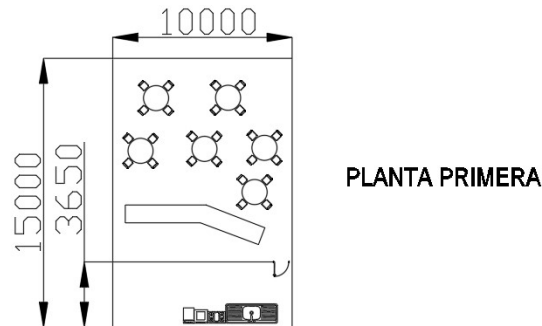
Distribución en planta primera (cotas en mm).
